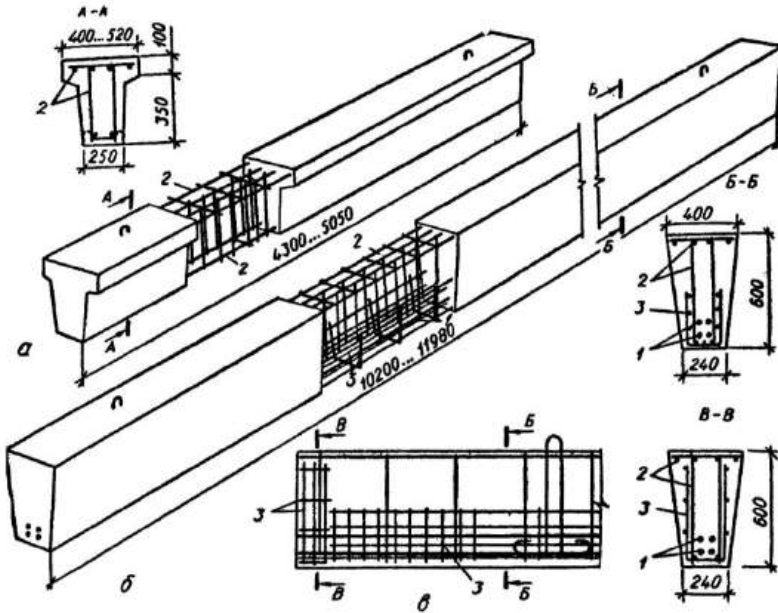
Фундаментні балки: *a* – при кроці колон 6м; *б* – попередньо напружені при кроці колон 12м; *в* – армування опорної частини попередньо напруженої балки; 1 – попередньо напружена арматура; 2 – зварний каркас; 3 – зварна арматурна сітка
